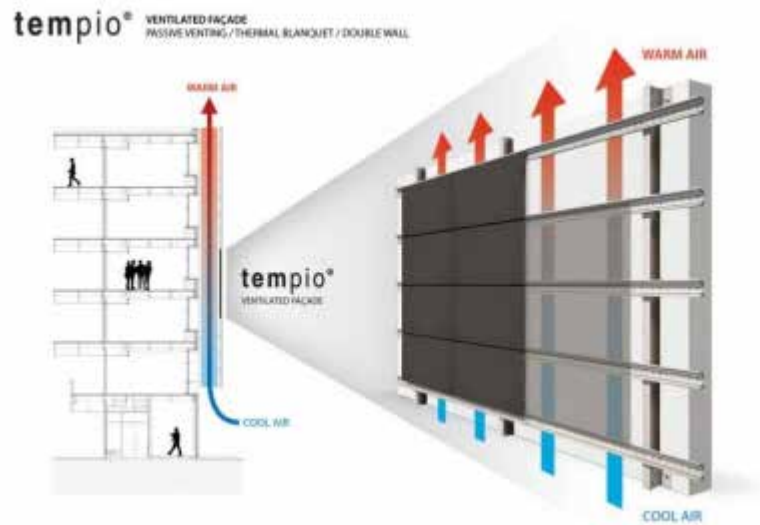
Esquema de Fachada Transventilada fuente:Tempio (2016)
